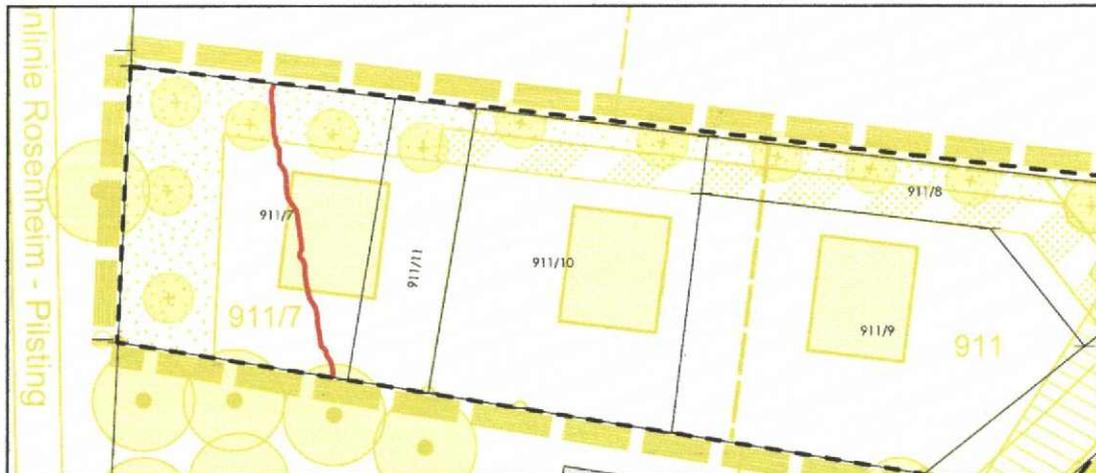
Lageplan mit Eintragung des Mindestabstands zur Bahnlinie im Westen
